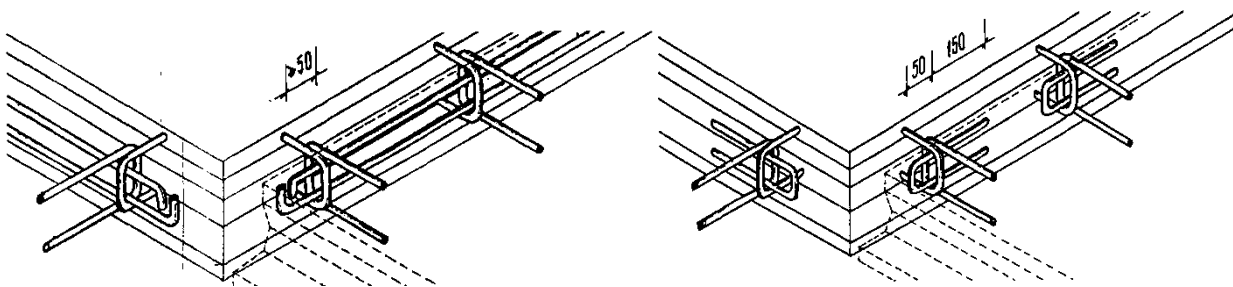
Схема армування стків плит перекриття перед бетонуванням.
